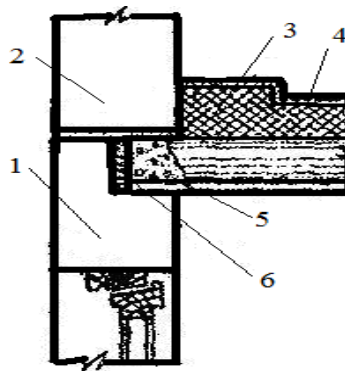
Утеплення горищного перекриття при приляганні до стіни: 1 – стіна над перемичкою; 2 – стіна горища; 3 – теплоізоляційний матеріал; 4 – стяжка; 5 – панель перекриття; 6 – утеплювач
